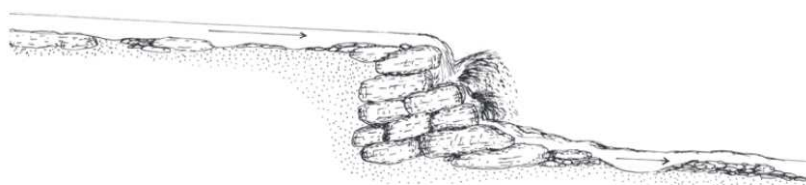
Rappresentazione schematica di un salto d'acqua in massi in sostituzione delle classiche briglie di calcestruzzo e cemento.
